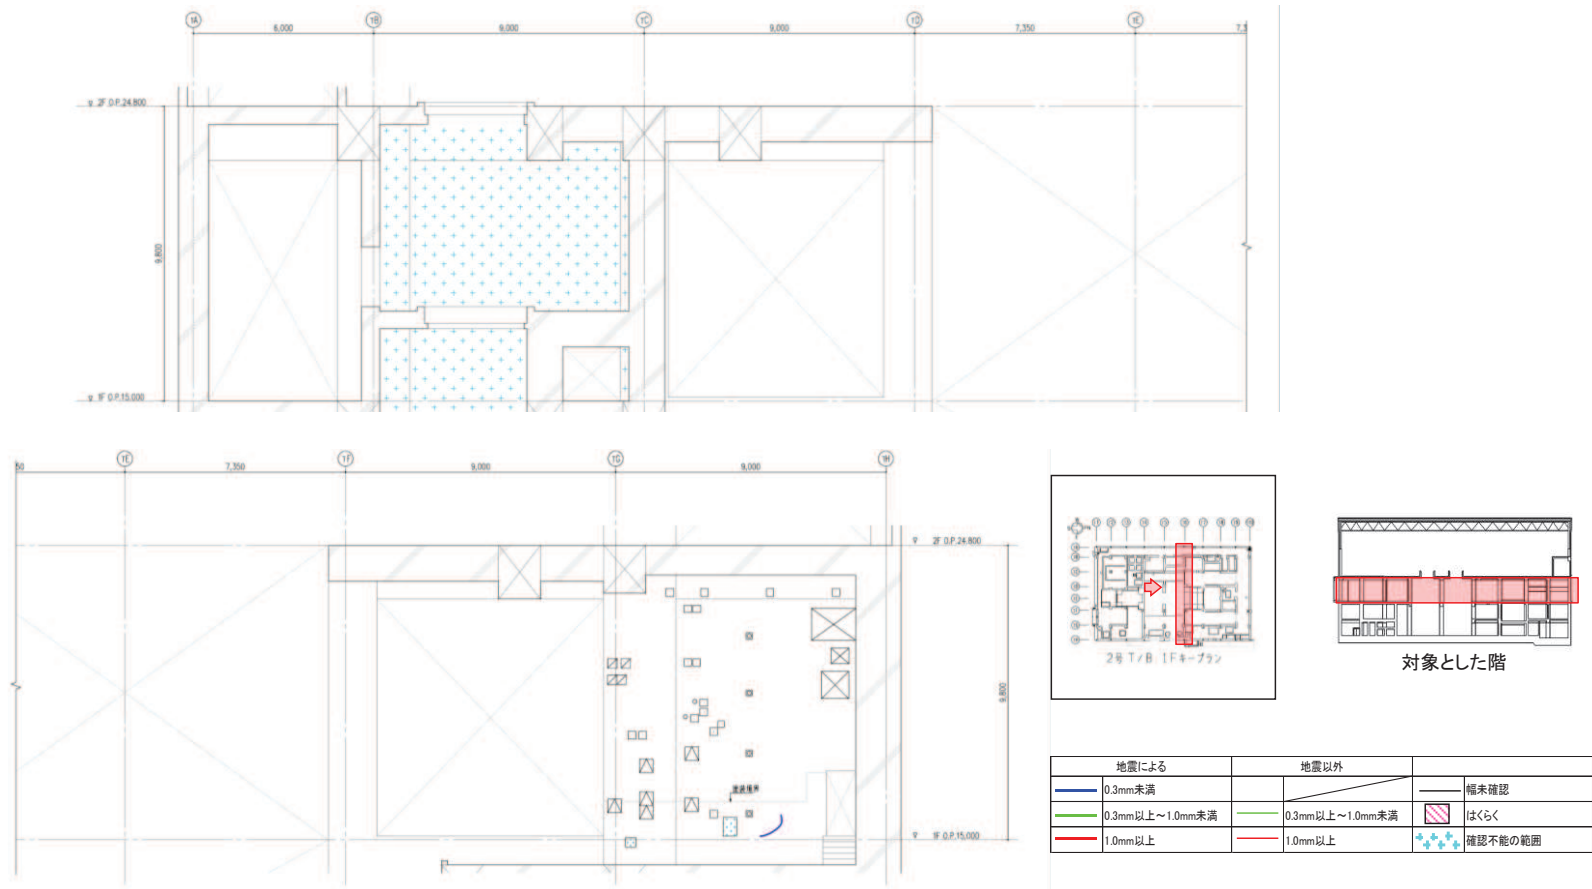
タービン建屋のひび割れ分布 耐震壁 (38) 1階 T6 通り
